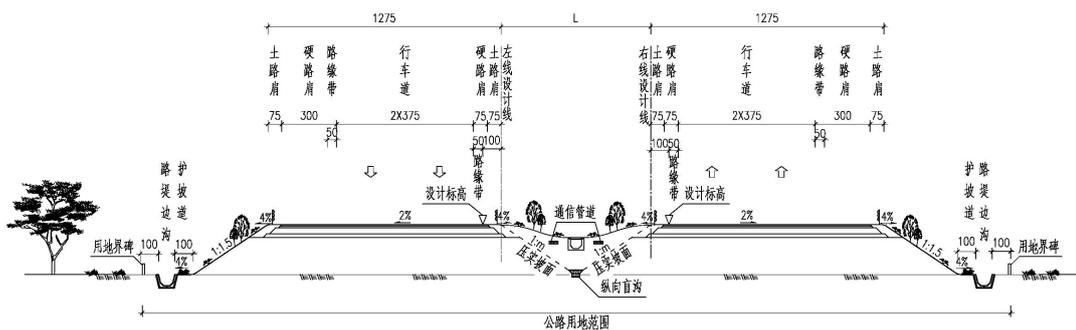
一般路段（分离式路基段）路基横断面布置
